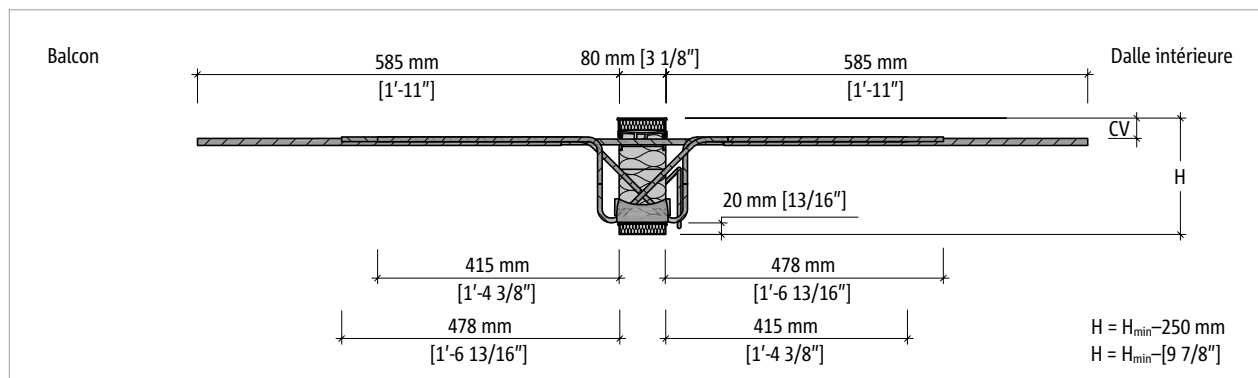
Schöck Isokorb® T Type CK-M6-VV1 à M11-VV1 : coupe transversale du produit
